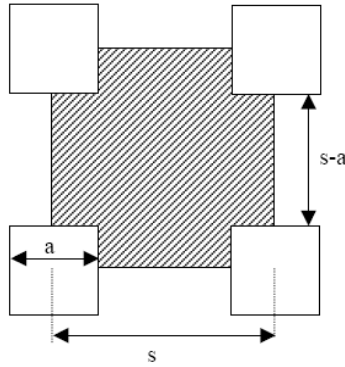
11 - Tranche de sol de section cruciforme, cas 3D (d'après Russell & Pierpoint, 1997)
